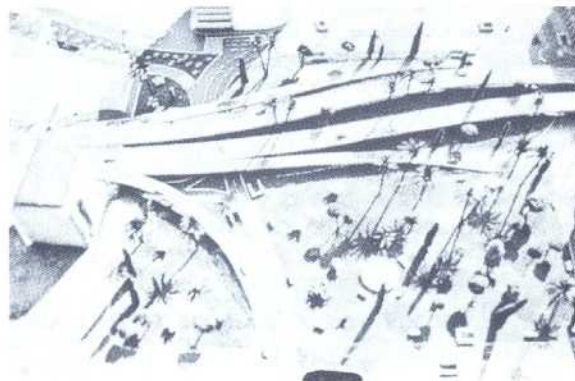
Propuesta de paso elevado por la Plaça de Lesseps (*).
